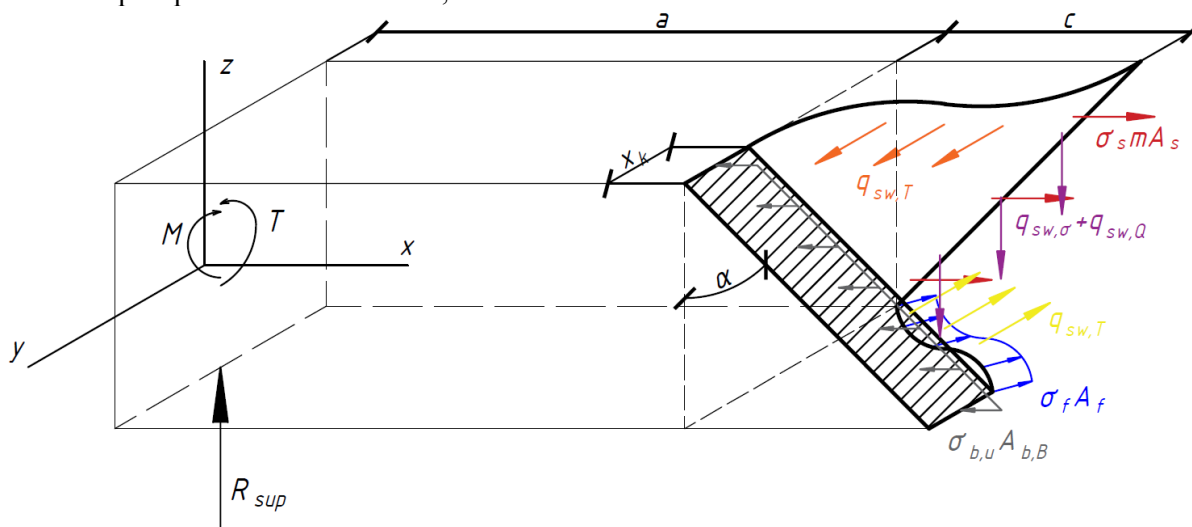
Предполагаемые усилия в пространственном сечении в железобетонном элементе с внешним композитным армированием при изгибе с кручением, для схемы II расположения сжатой зоны
